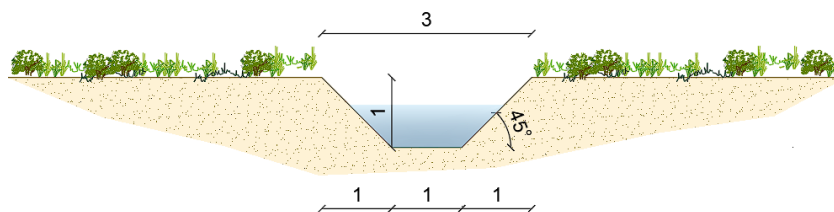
Sezione trasversale del canale in progetto "Tipo 2"
